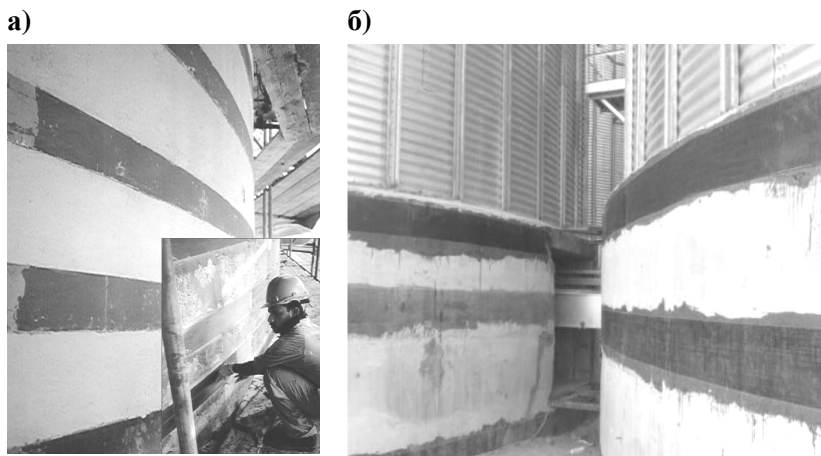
Усиление железобетонных конструкций цилиндрической формы внешним углеволокном фибропластиковым армированием: а — элементов башни *Qafco Prill Tower*, Катар [59], б — опор силосов, Российская федерация [61]
